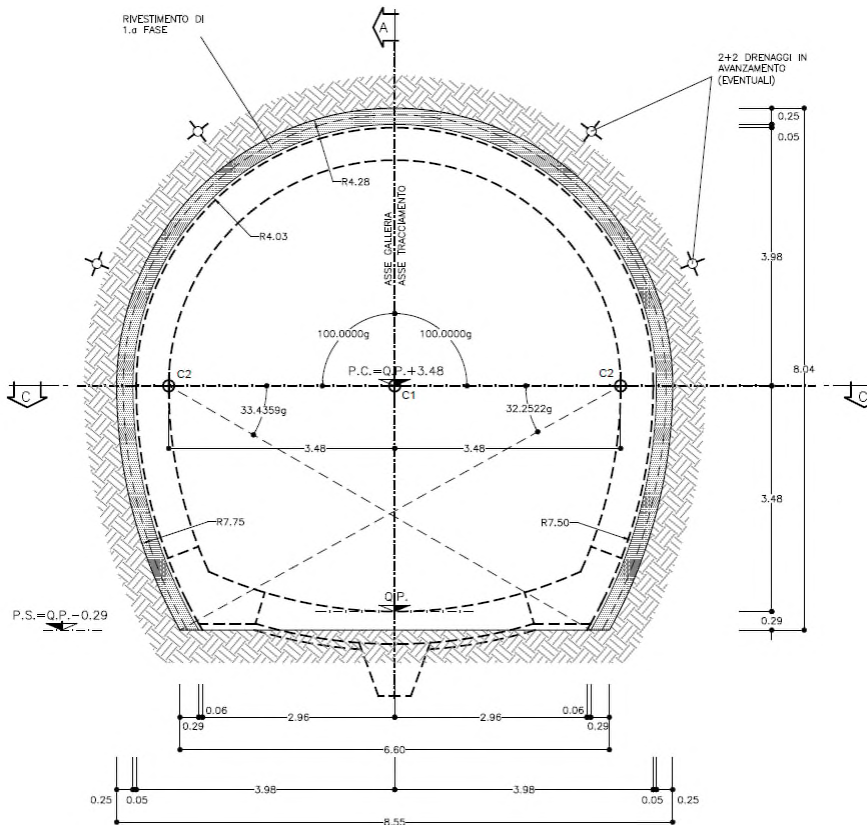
Sezione Tipo Ac – Scavi e consolidamenti - Sezione
